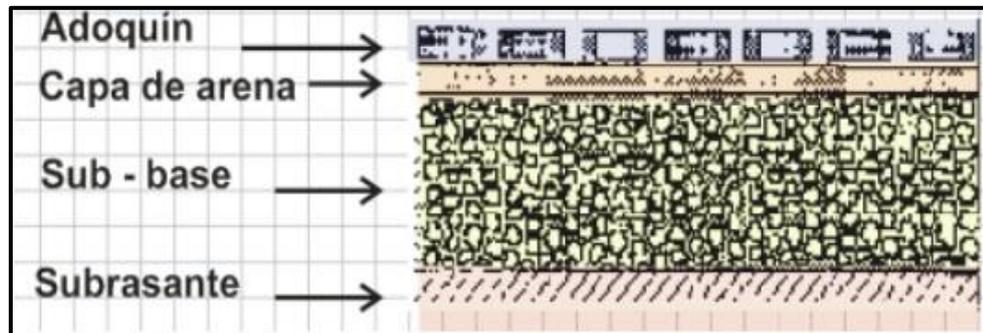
Pavimento Semirígido – Fuente elaboración propia 2017
